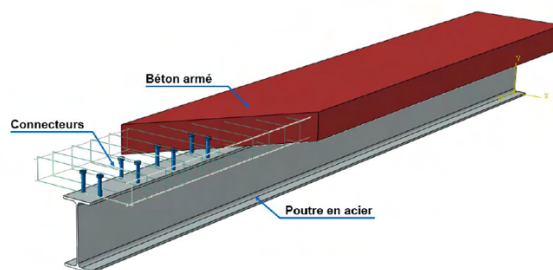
Poutre mixte acier-béton avec connecteurs soudés [2]
